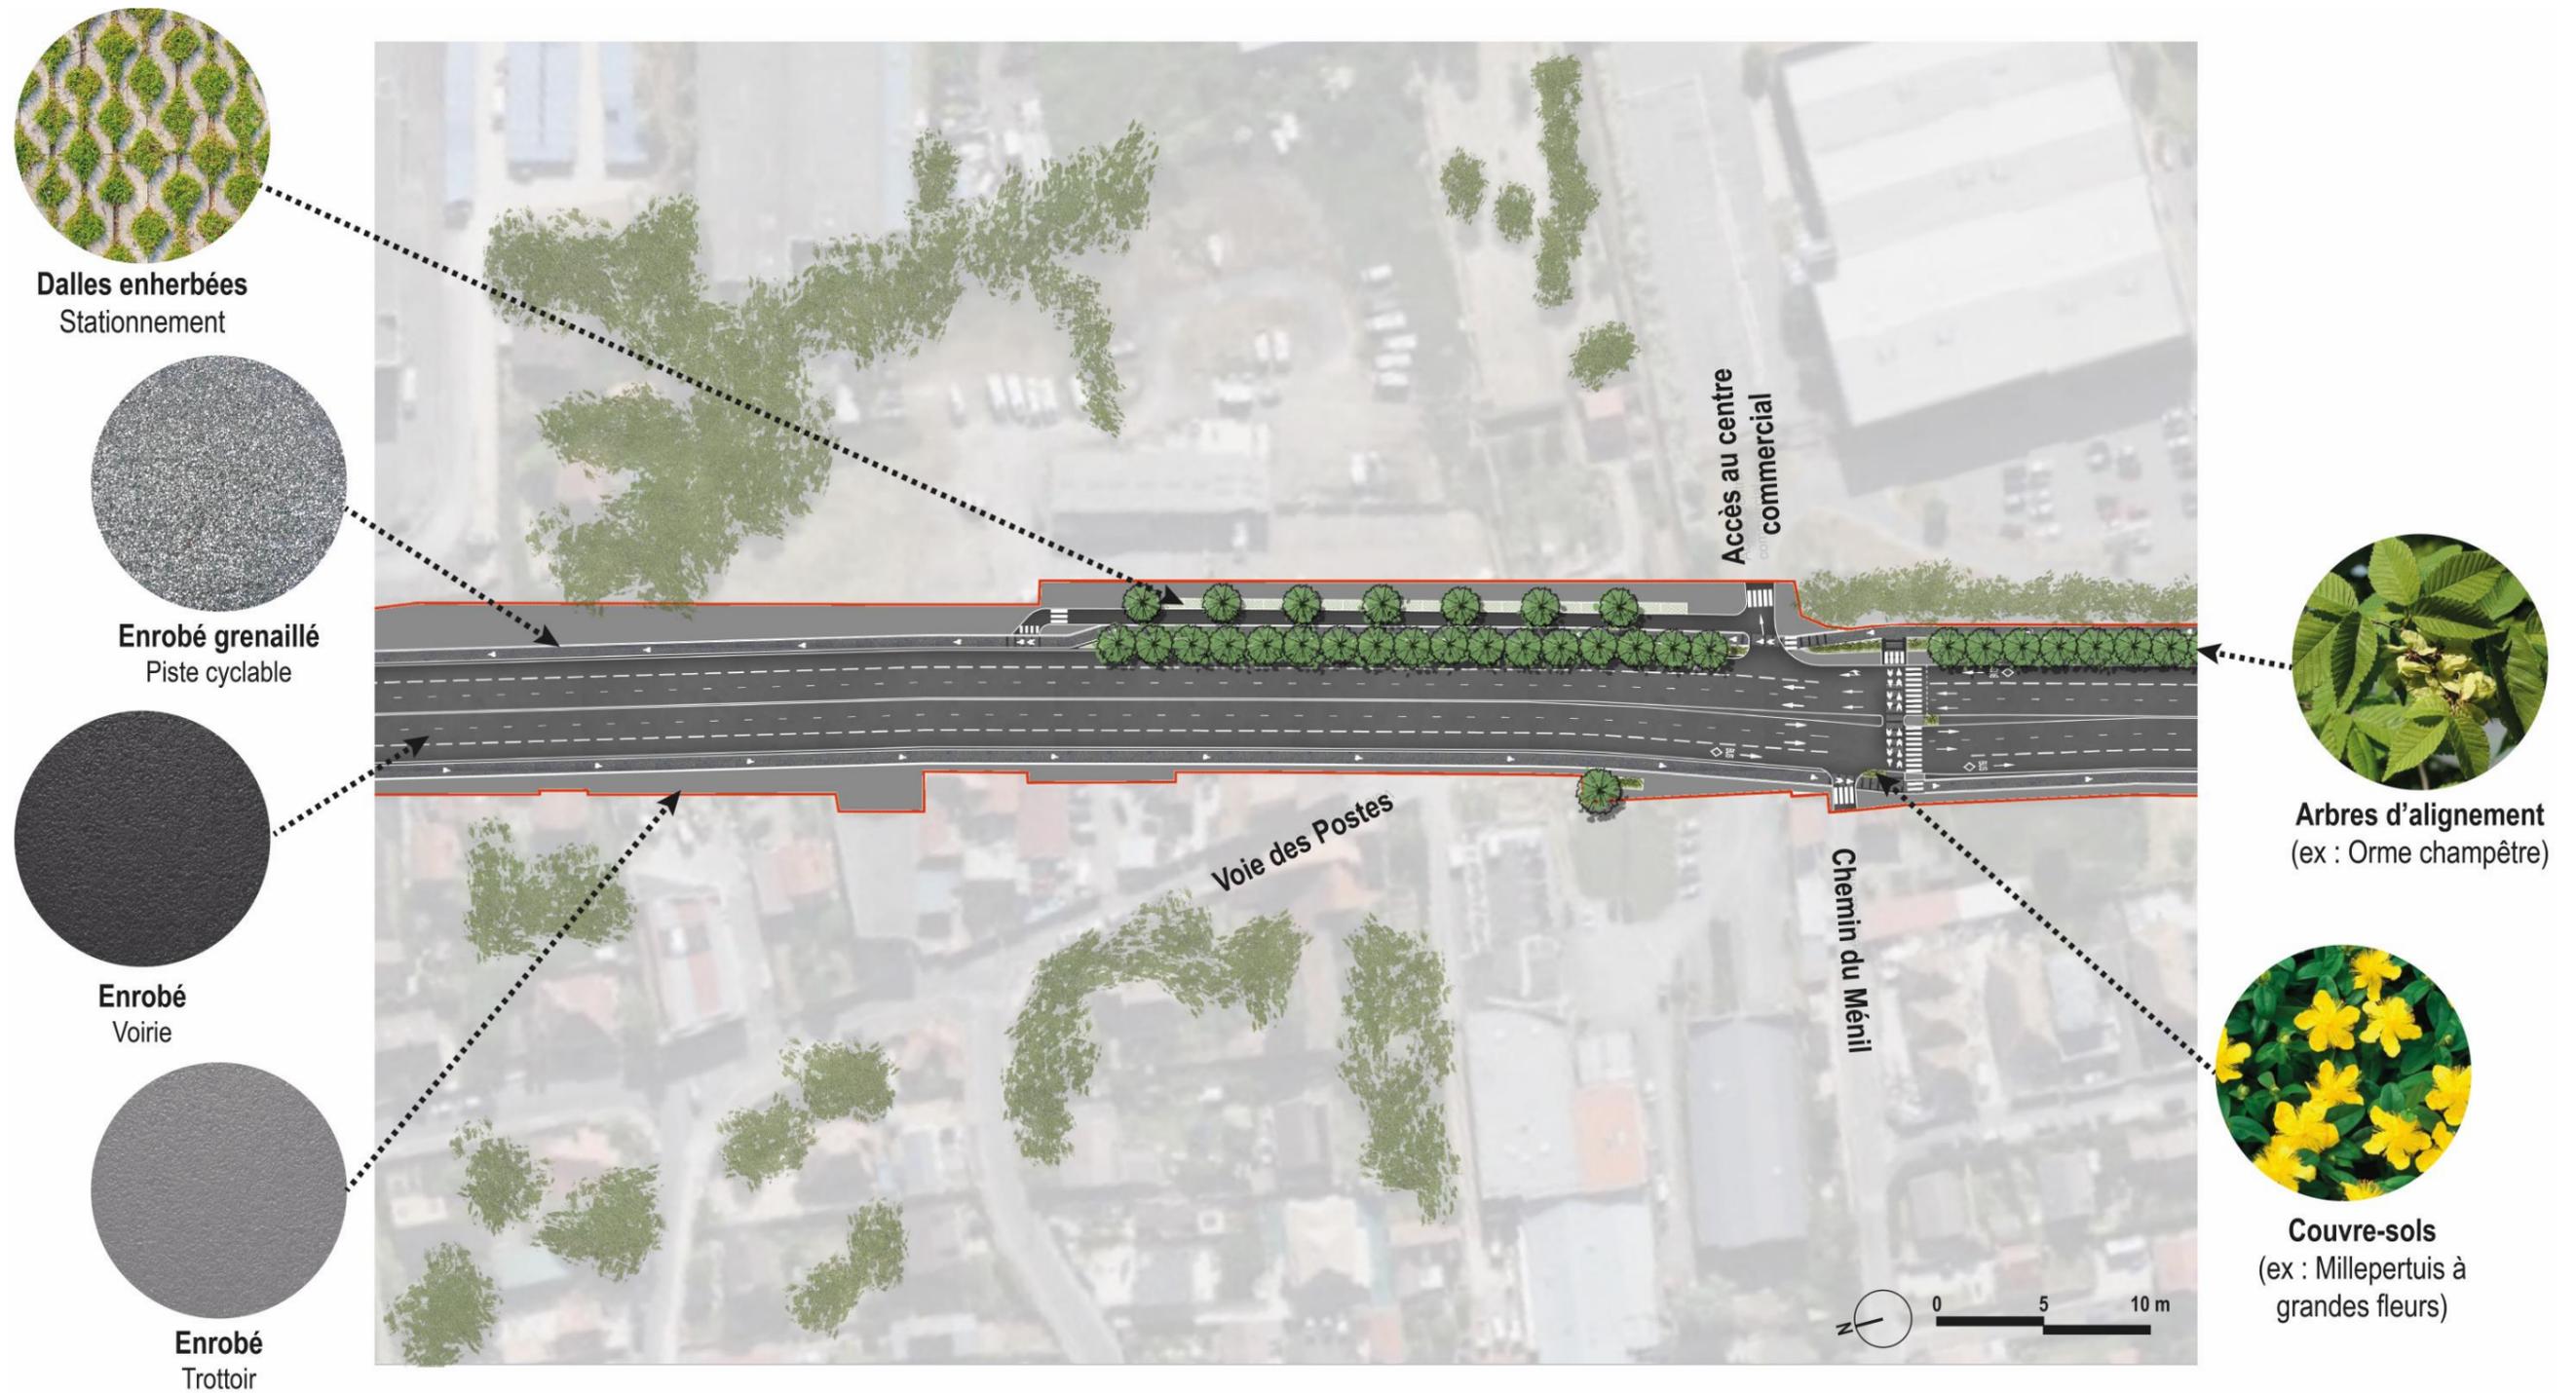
Plan d'aménagement de la RN20 et ses abords en situation de section courante, Source : Ingérop
